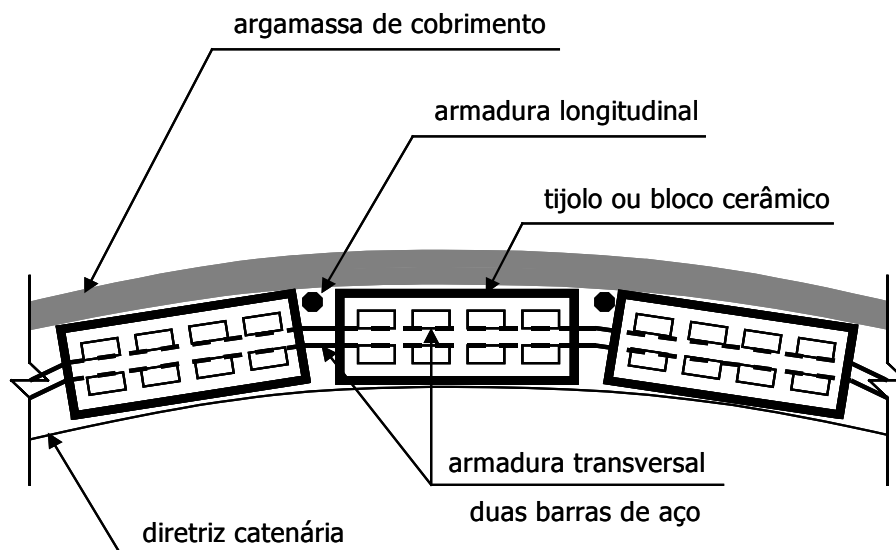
Corte esquemático: colocação das armaduras longitudinal e transversal nas abóbadas.
